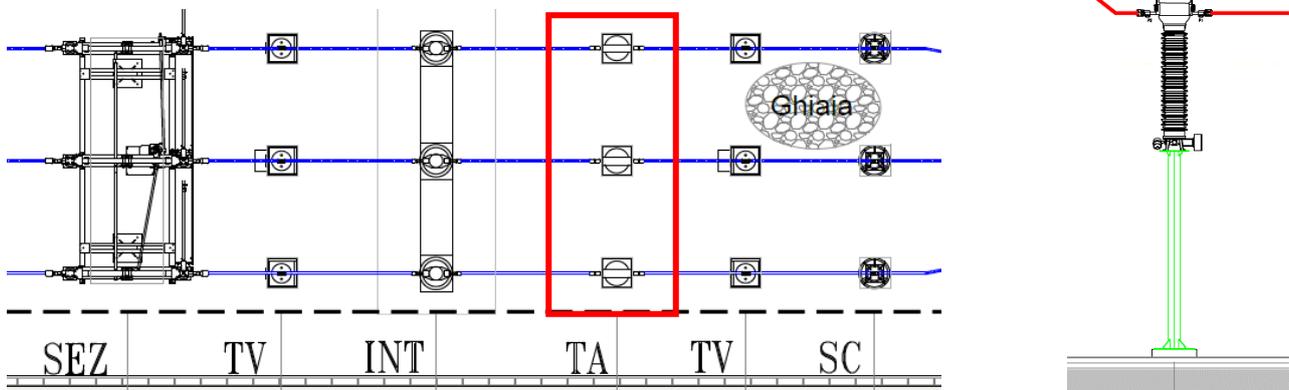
Tipico trasformatore di corrente – vista prospettica e planimetrica
